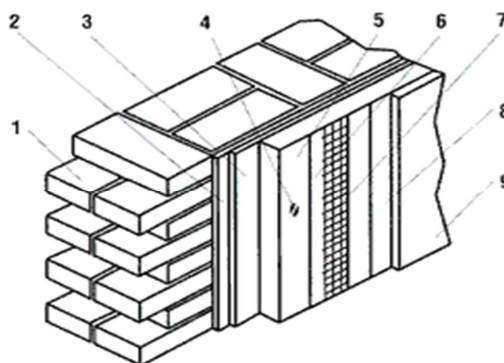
Схема устройства системы «скрепленной» теплоизоляции: 1 – утепляемая стена; 2 – старая наружная отделка; 3 – клеевой состав; 4 – дюбель для крепления утеплителя; 5 – утеплитель из минеральной ваты или полиполистирола; 6 – клеевой армирующий состав; 7 – армирующая сетка; 8 – грунтовка; 9 – отделочный слой
